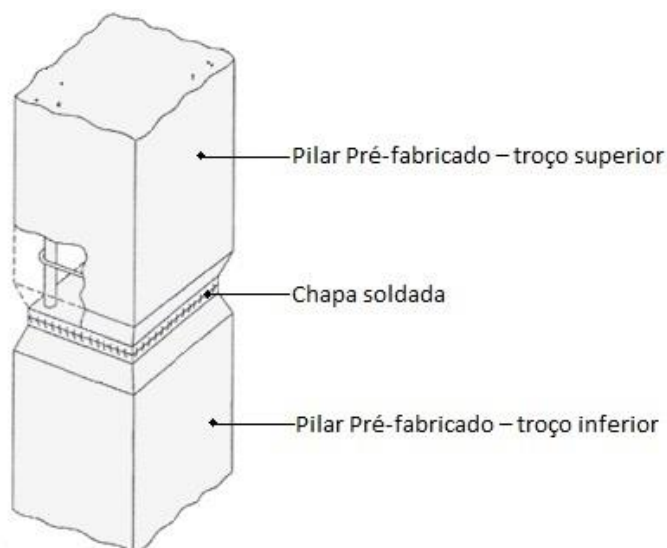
Ligação Pilar – Pilar por chapas soldadas [46]
